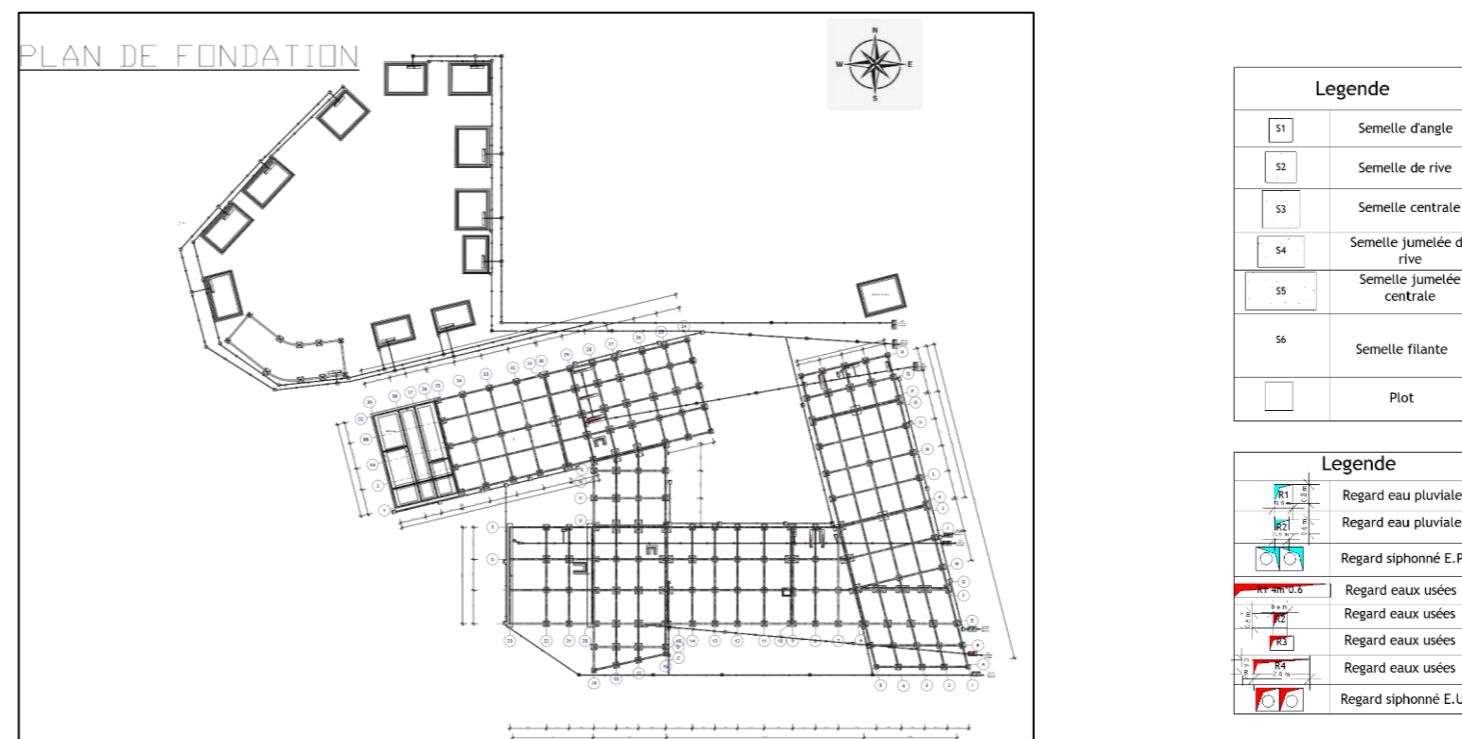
Un plan de fondation et d'assainissement (Voir Annexe)
